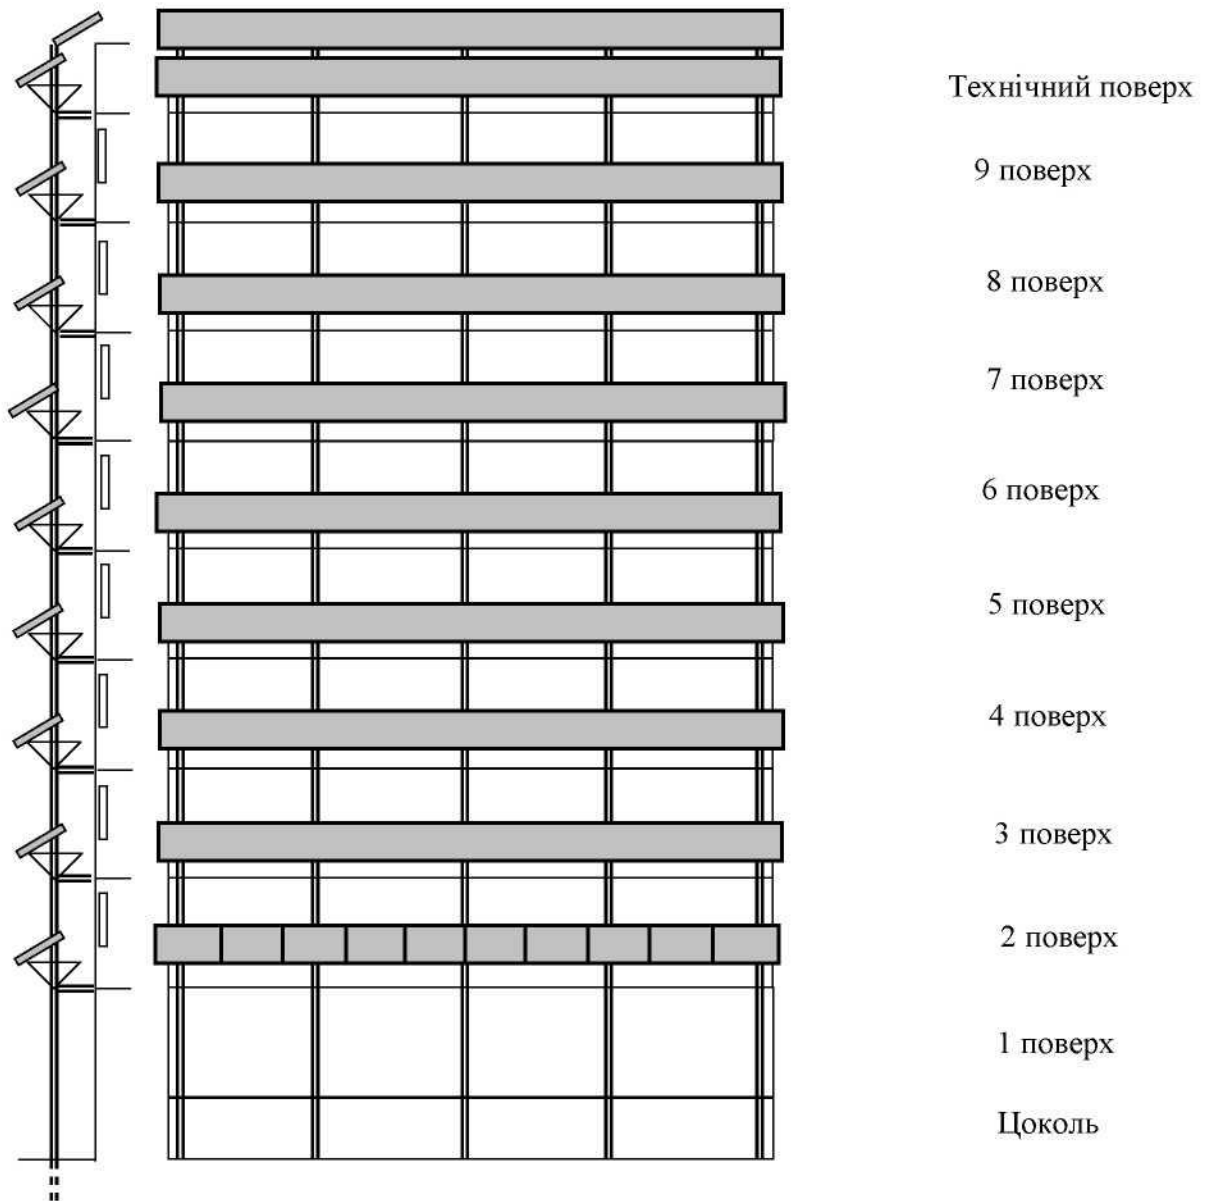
Креслення секції фасаду та силового каркасу
